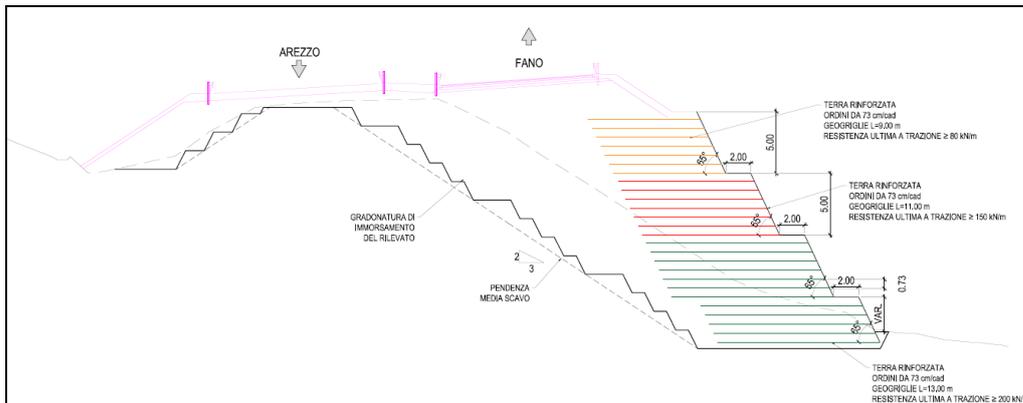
Sezione schematica del rilevato in terra rinforzata dalla pk 1+980 alla pk 2+110
